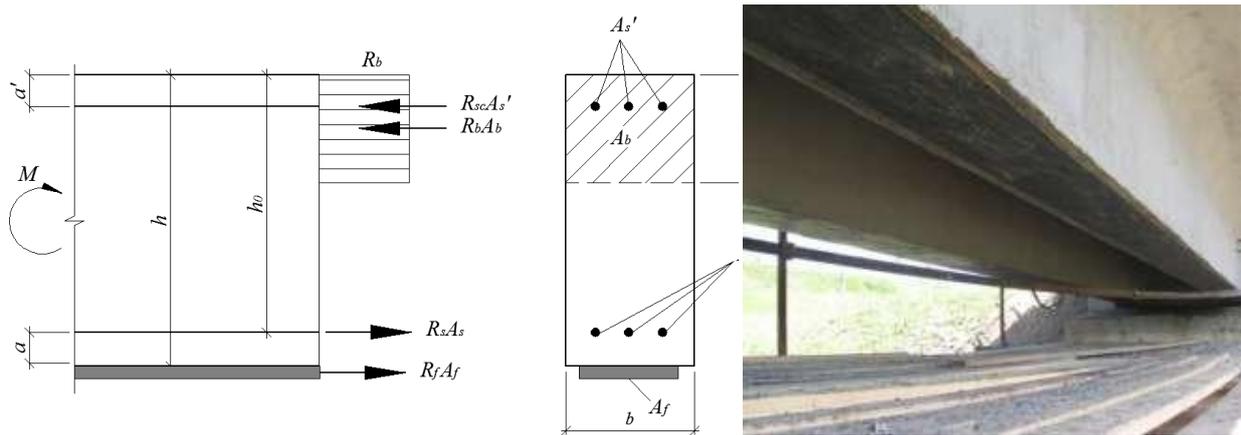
Схема усилий и эпюра напряжений в сечении, нормальном к продольной оси изгибаемого железобетонного элемента с внешним армированием из композитных материалов, при его расчете по прочности
